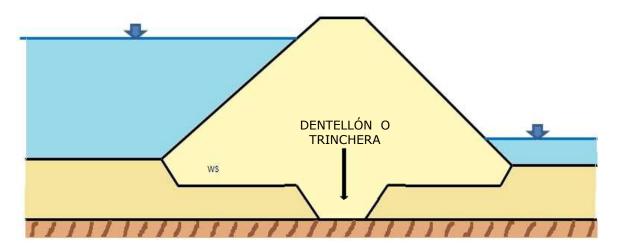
III.1.2.2 Tratamiento de la superficie de cimentación con dentellón o trinchera.
